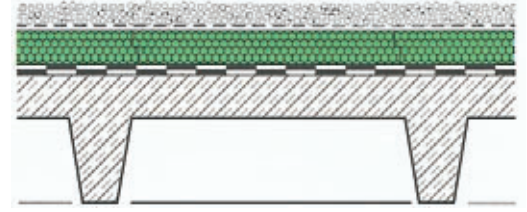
Schichtaufbau des bekiesten Umkehrdaches mit reduzierter Kiesauflast, K 3. Kiesschüttung
